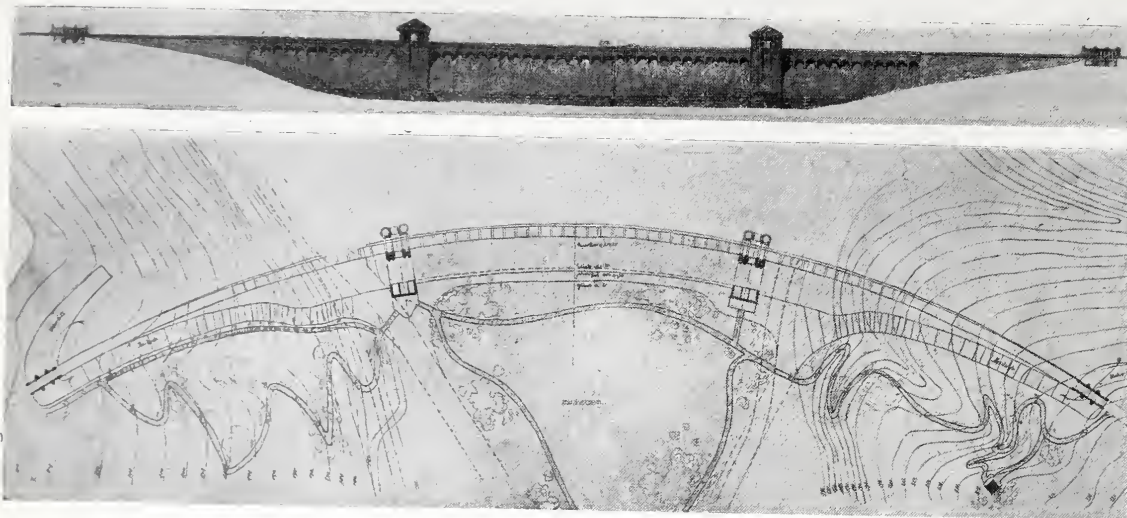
Ansicht und Grundriß der Sperrmauer.
